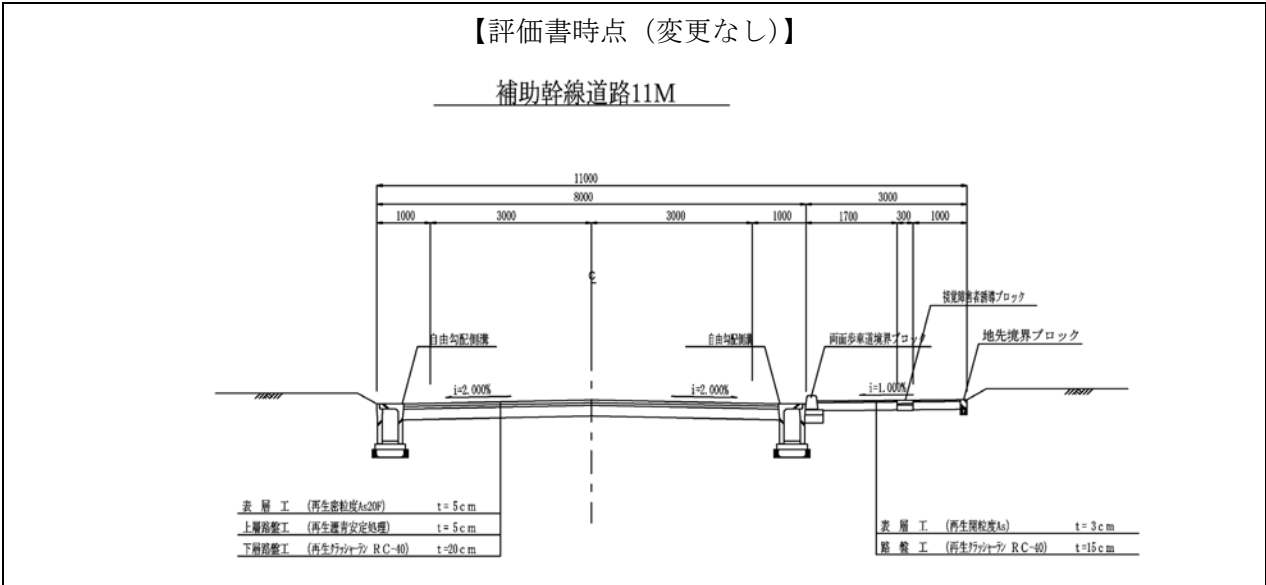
(4) 道路断面図(補助幹線道路:11m 標準断面)
